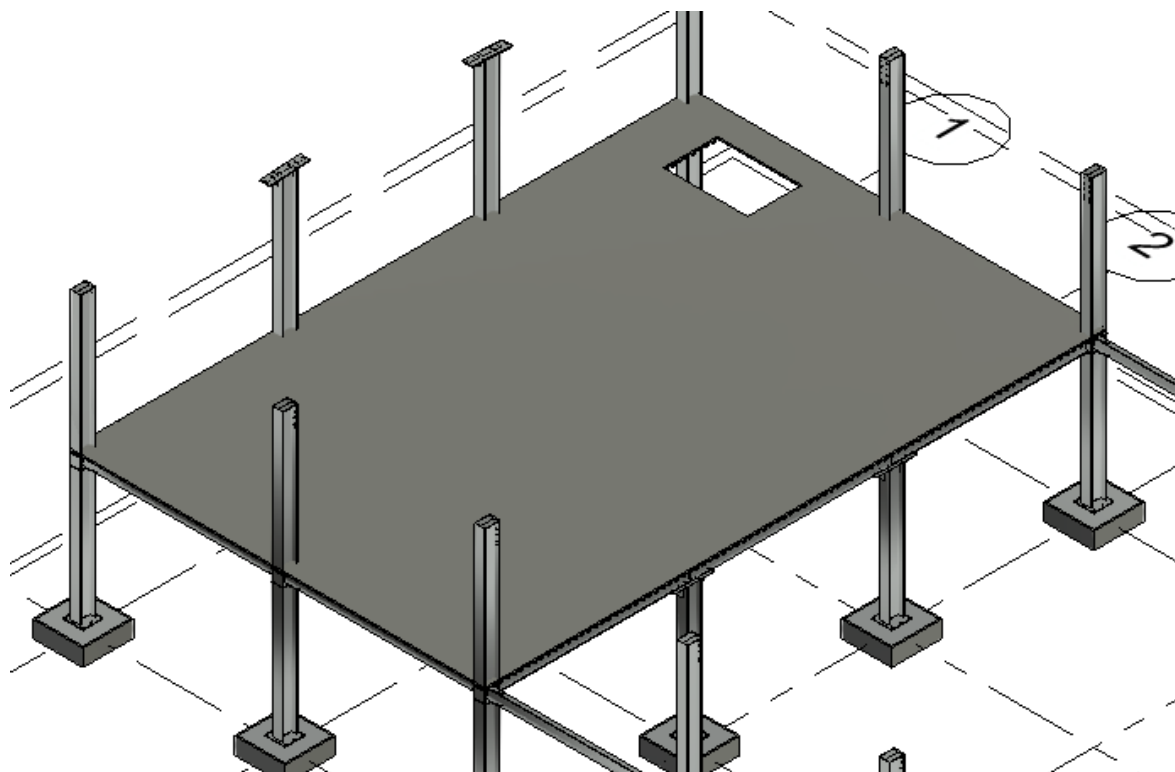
Col·locació del mallat i l'armadura i el formigó pel forjat col·laborant. (Font: "Revit")
